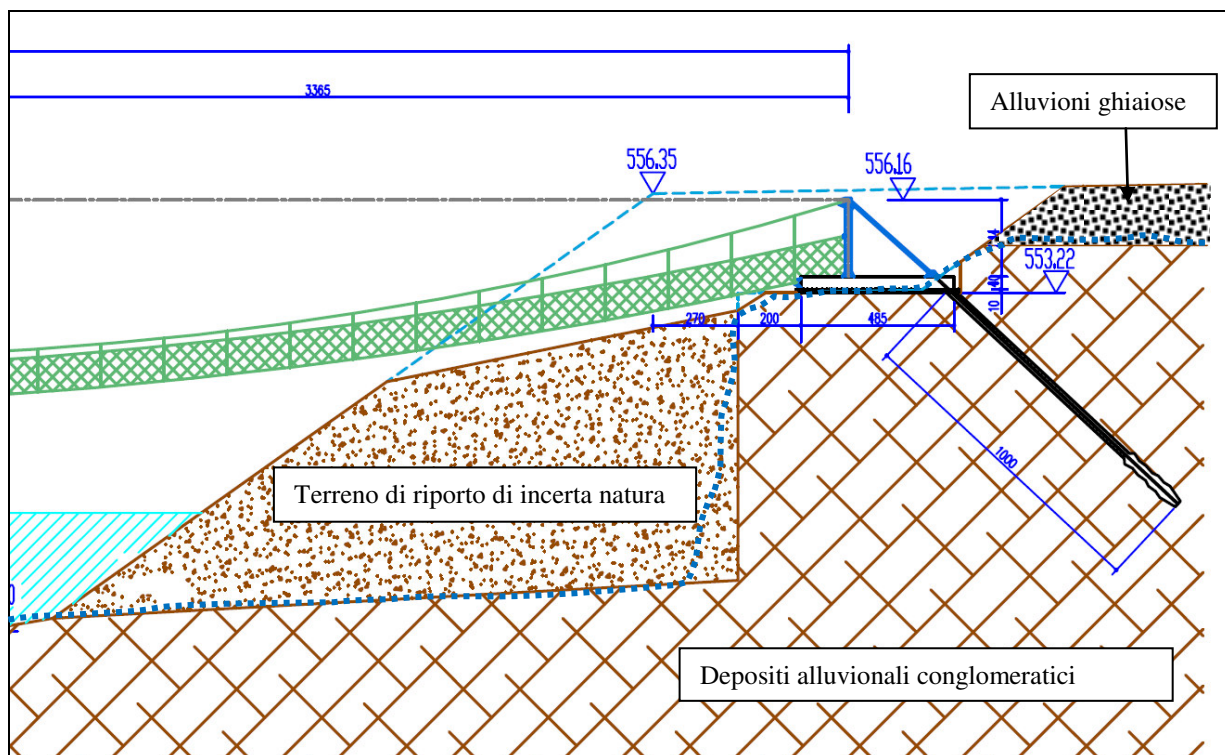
Sezione di progetto con la posizione del sistema di fondazione e:
